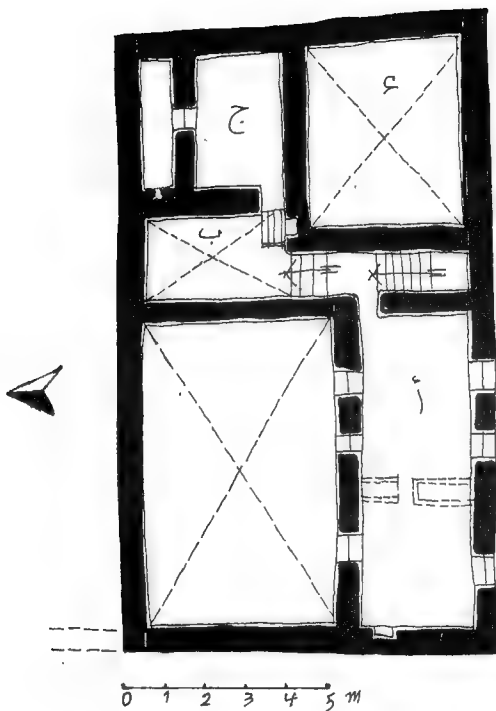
منزل ابو همام الدور الأرضي المستوى الأول - مسقط أفقي
